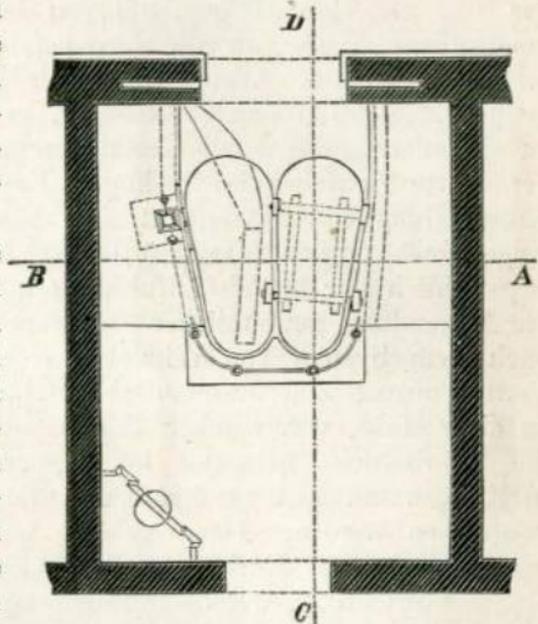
Bad Elster i. S. (Moorbadezelle, Grundriss.)
